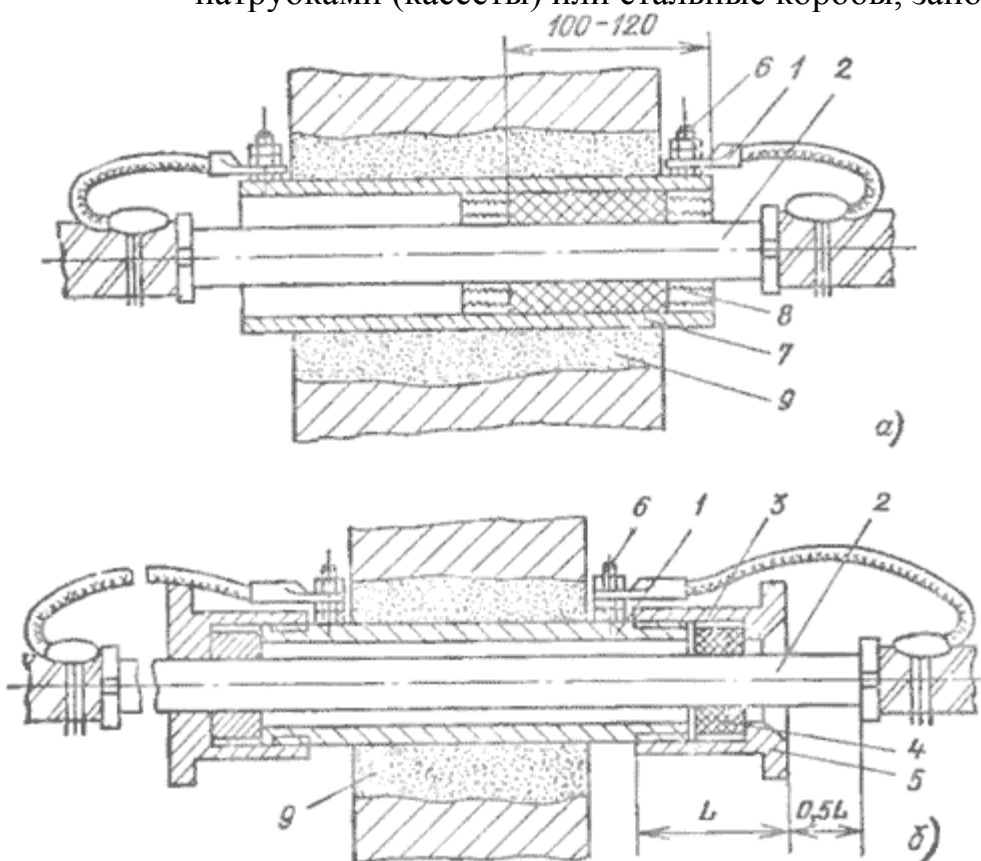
Проходы кабелей через стены взрывоопасных помещений: а — с уплотнением составом УС-65; б — с сальниковым уплотнением; L — длина сальника; 1 — отрезок трубы; г — кабель; 8 — сальник; 4 — уплотнительное резиновое кольцо; 5 — шайба; б — болт заземления; 7 — уплотнительный состав УС-65: 8 — уплотнения из кабельного джута или асбестового шнура; У — цементный раствор
